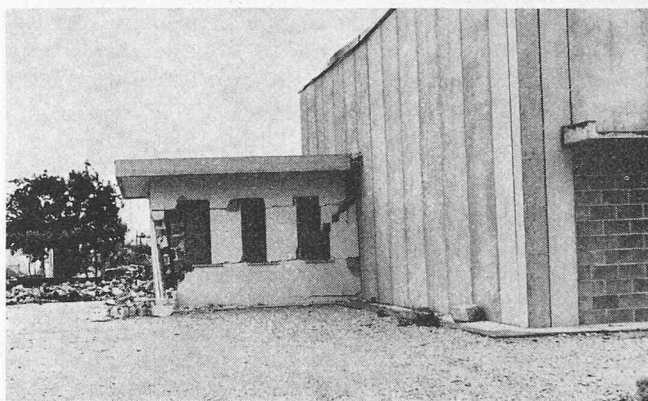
Vorfabrizierte Lagerhalle mit Backsteinanbau in Gemona. Tragskelett der Halle unbeschädigt. Steinwand bei Aufprall an steifen Anbau leicht eingedrückt. Dach des Anbaus durch die Impulsbelastung nur geringen Widerstand entgegensetzen können und wenig plastische Deformationsmöglichkeiten aufweisen. Wegen der Verwendung reiner Reibungsverbindungen war die Stabilität der Tragkonstruktion oft nicht gewährleistet. Dagegen haben gut verankerte Betonelemente für die Fassade wesentlich zum befriedigenden Verhalten einiger Bauwerke beigetragen. Kleinere stabilisierende Bauteile aus Mauerwerk konnten die grossen Beanspruchungen der weichen Tragstruktur nicht wesentlich behindern und wurden oft zerstört.
